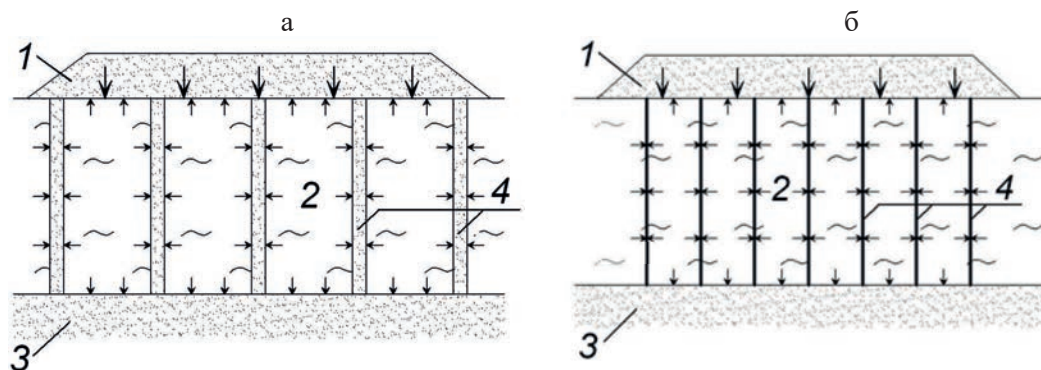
Принципиальные схемы уплотнения слабых грунтов пригрузочной насыпью с вертикальными дренами: а — с песчаными дренами; б — с ленточными дренами; 1 – пригрузочная насыпь; 2 – слабый грунт; 3 – фильтрующий слой; 4 – дрена
